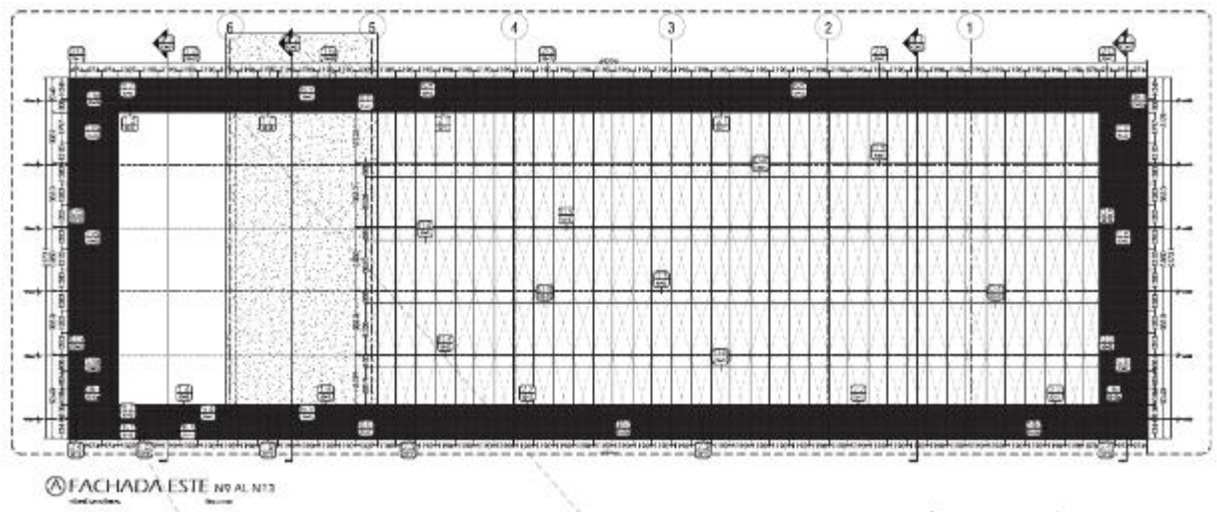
Detalle en planos fachada este, ejemplo de visualización de paneles en proyecto. Fuente: Extralum (2019)
